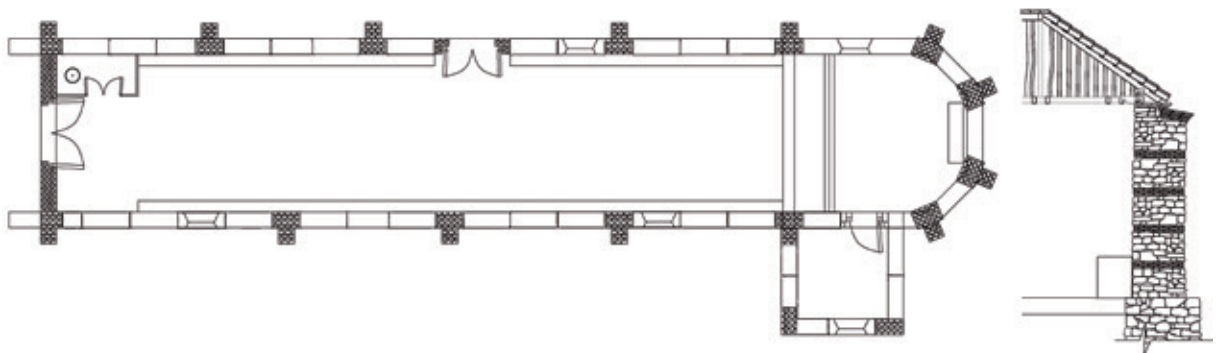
Planos de la iglesia de Ubaté, construida en tapia con verdugadas de ladrillo; rafas y contrafuertes de ladrillo, piedra y cal. Planta general y corte del muro testero²⁸.
